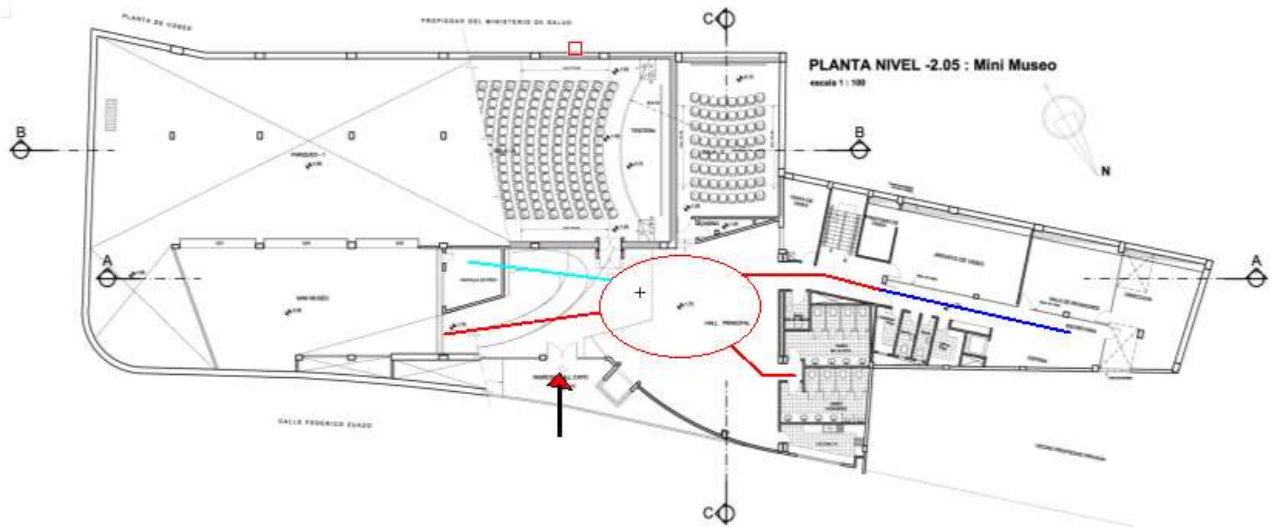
PLANTA NIVEL -2.05 CINEMATECA BOLIVIANA
